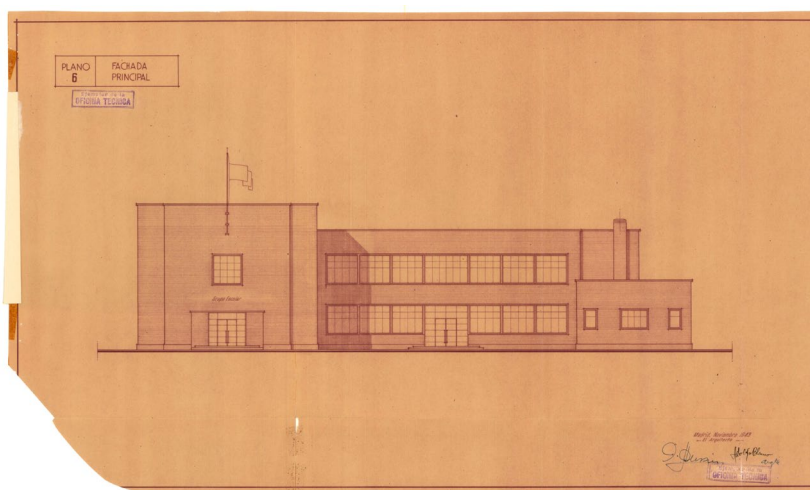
Grupo escolar en calle López de Hoyos (1943). Fachada principal.
